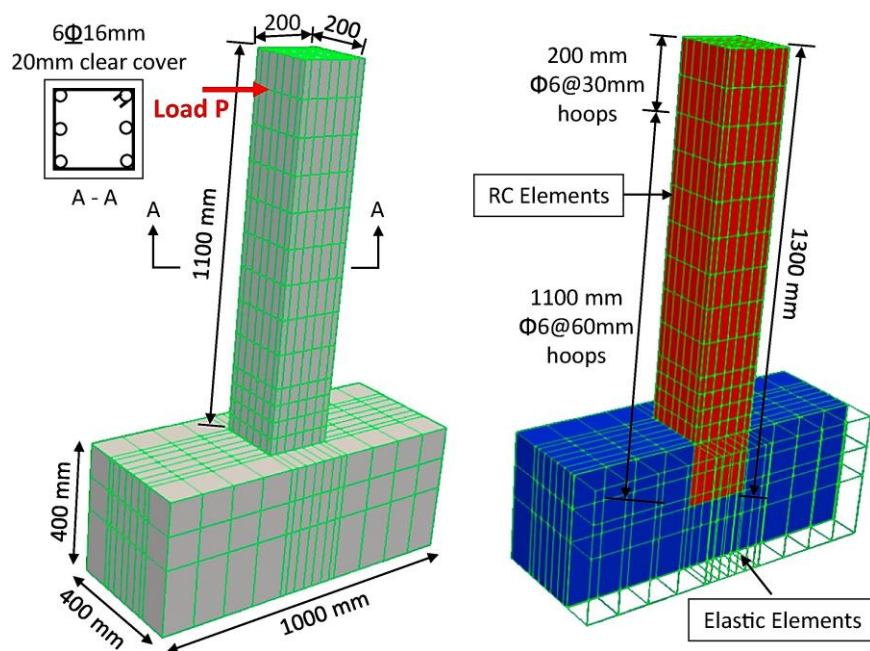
Malla 3D FEM de la columna RC y la disposición de las barras de refuerzo. Fuente: (Gong & Maekawa, 2018)
